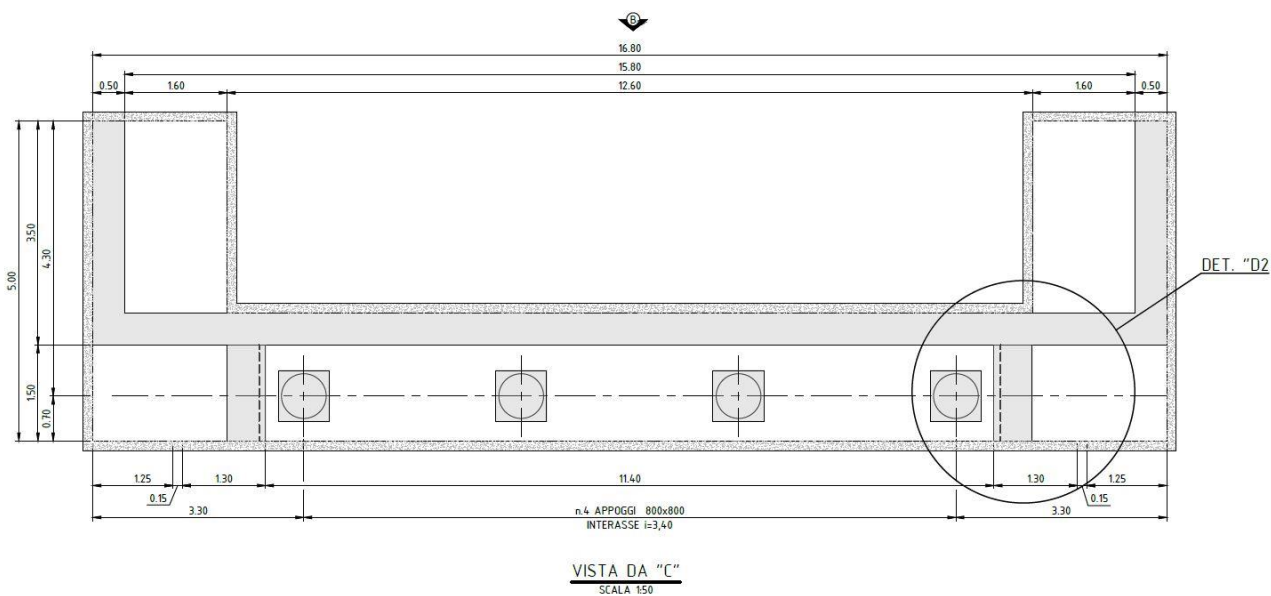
Vista in pianta della spalla (piano degli appoggi)
